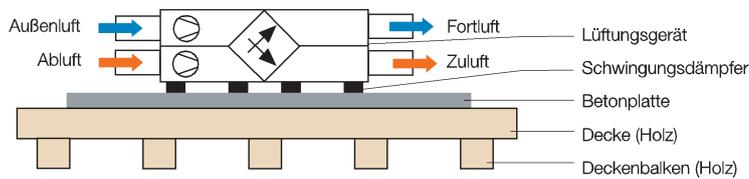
Schallentkoppelte Aufstellung auf einer Holzbalkendecke
